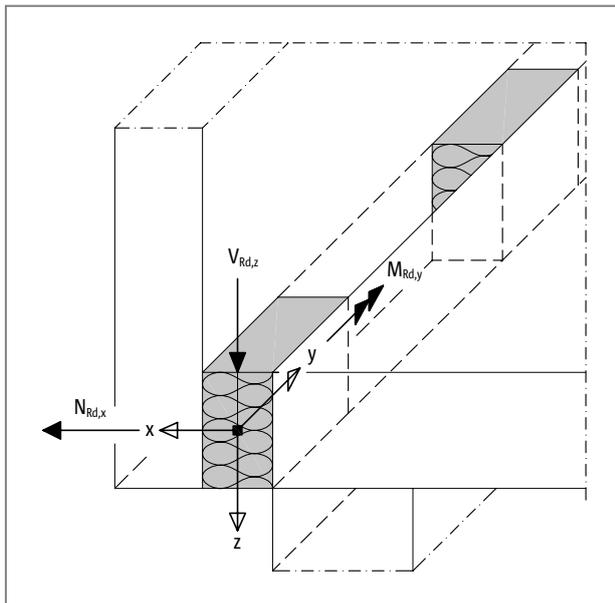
Schöck Isokorb® XT type F: Sign convention for the design
